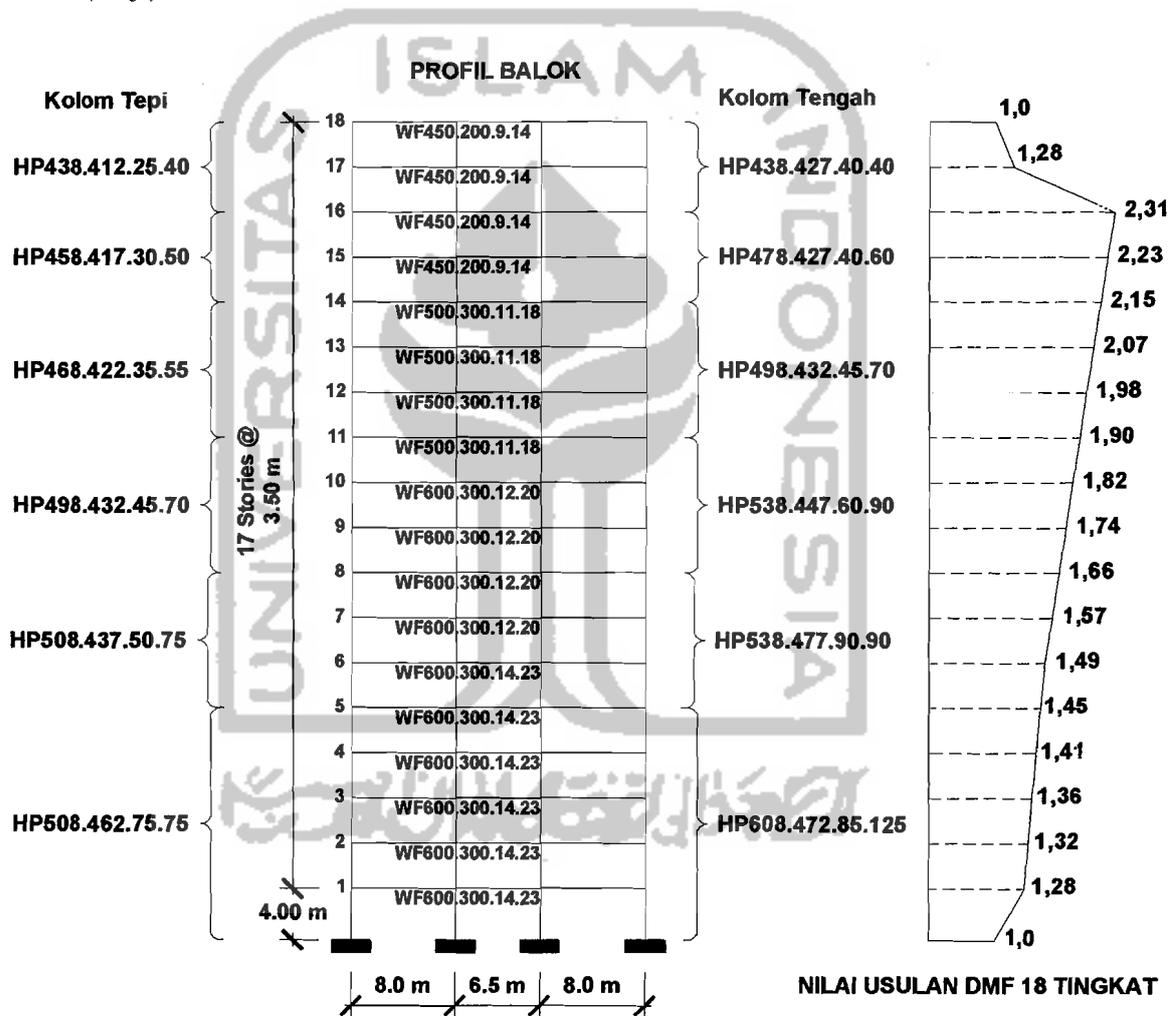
(b) Model 3-D Struktur Portal Baja 18 Lantai
